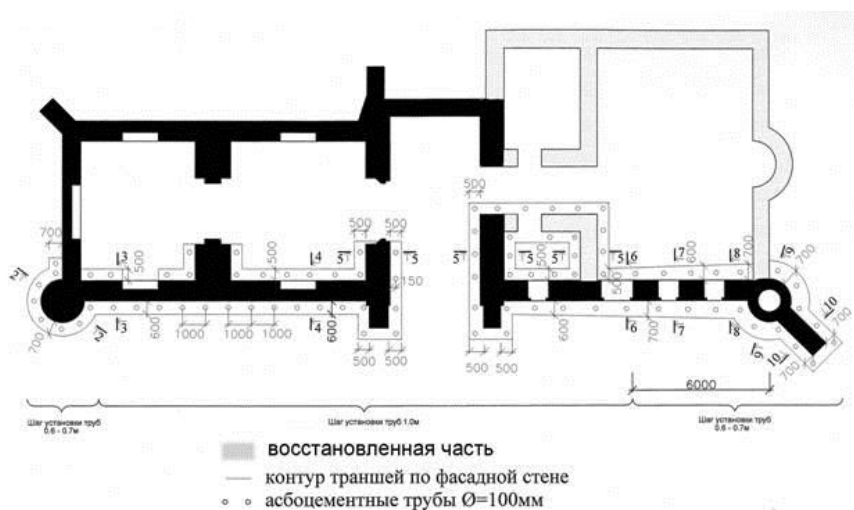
Схема расположения траншей и вентиляционных труб
